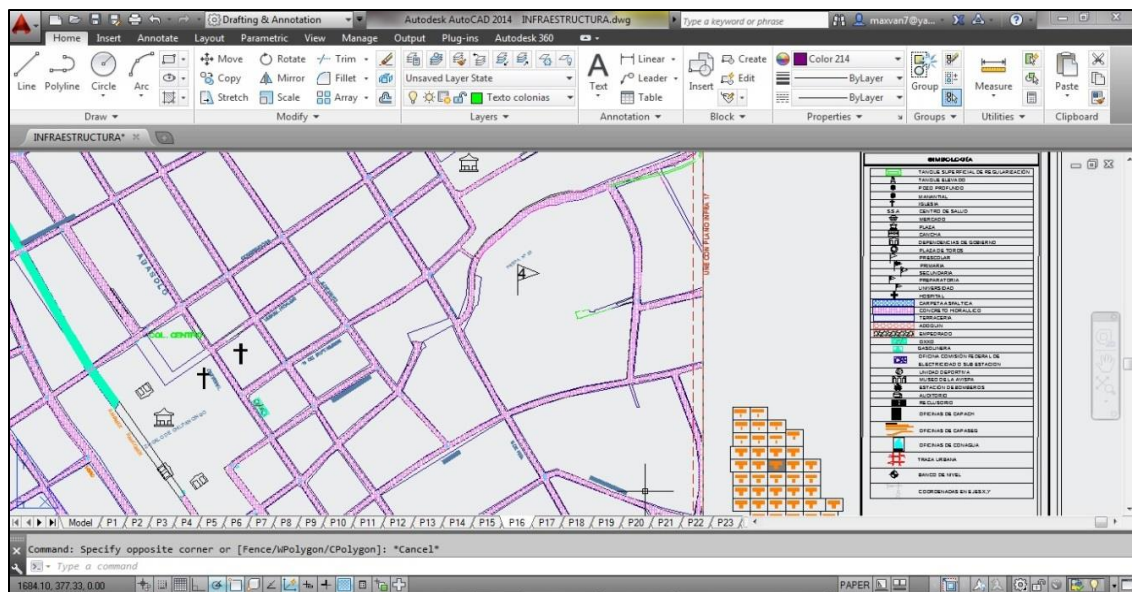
Detalle del plano de infraestructura en AutoCAD
